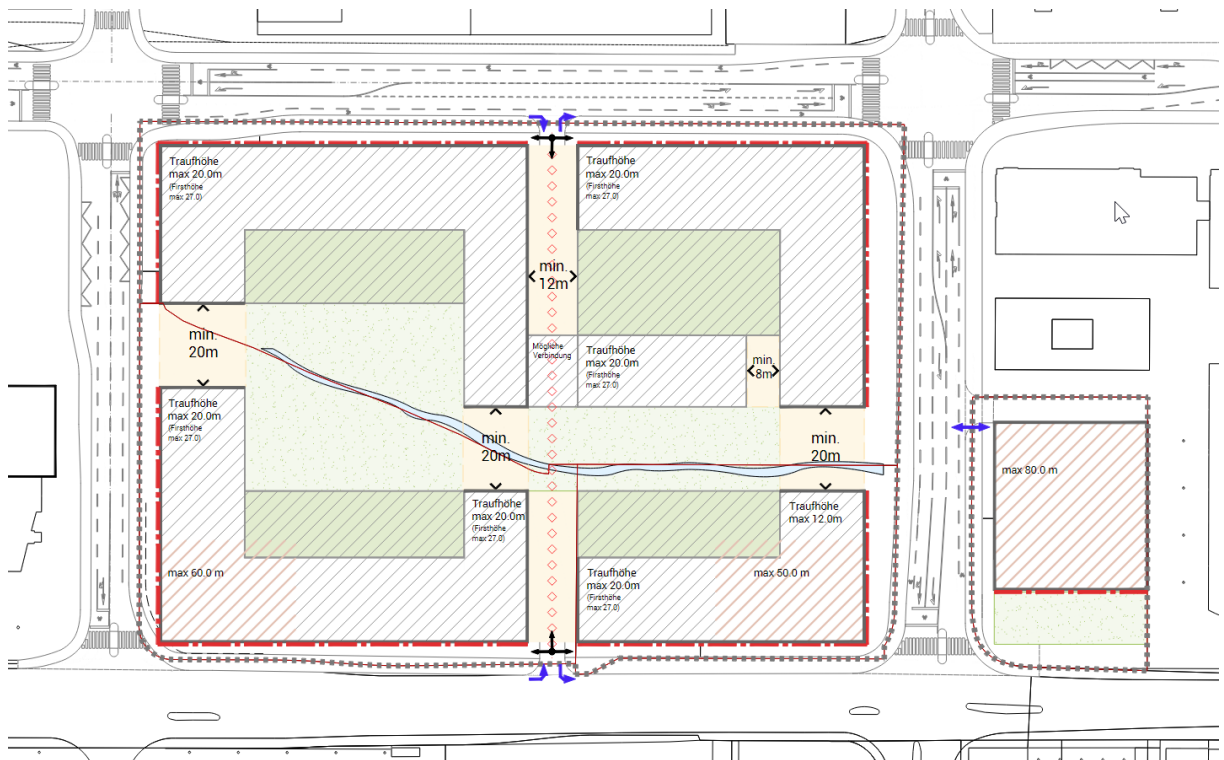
Entwurf Masterplan, Teil Planfeld 4, Stand 2016
